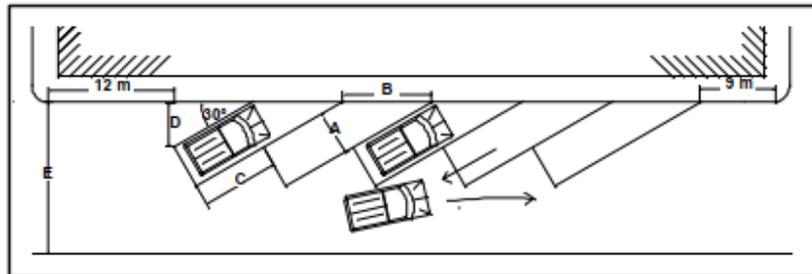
Parkir di badan jalan (*On Street Parking*)
